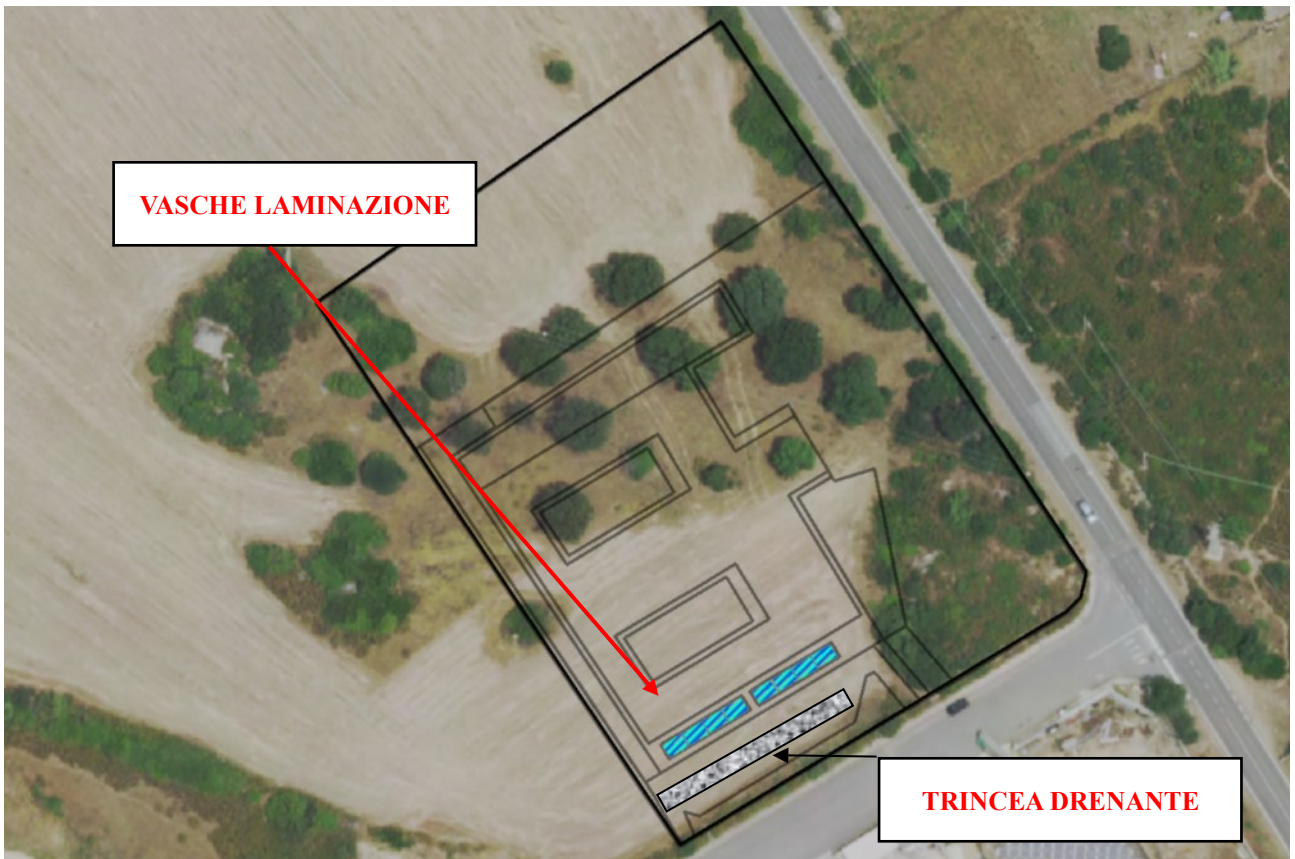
Lotto – Proposta posizionamento vasca di laminazione e trincea drenante
